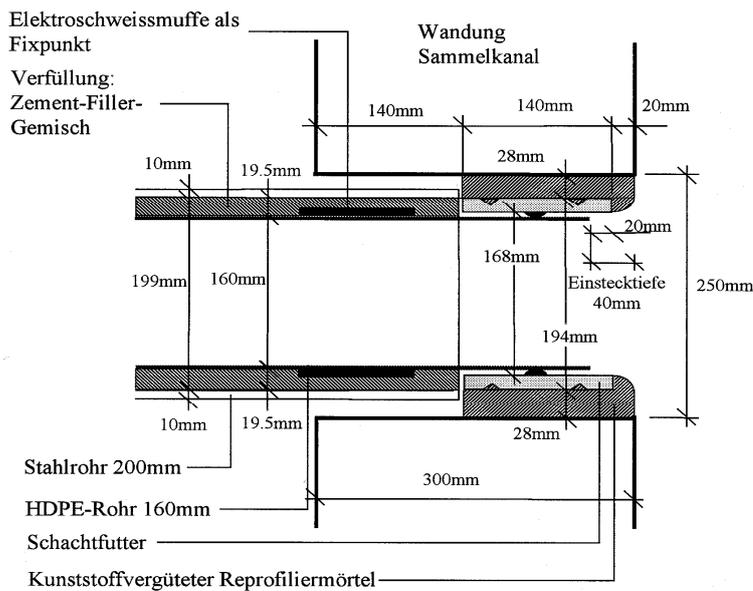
Anschluss einer HDPE 160 Hausanschlussleitung an einen Betonsammler
